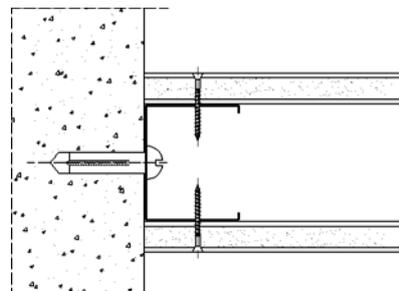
Départ de cloison sur maçonnerie pleine ou béton - Fixation par chevillage
